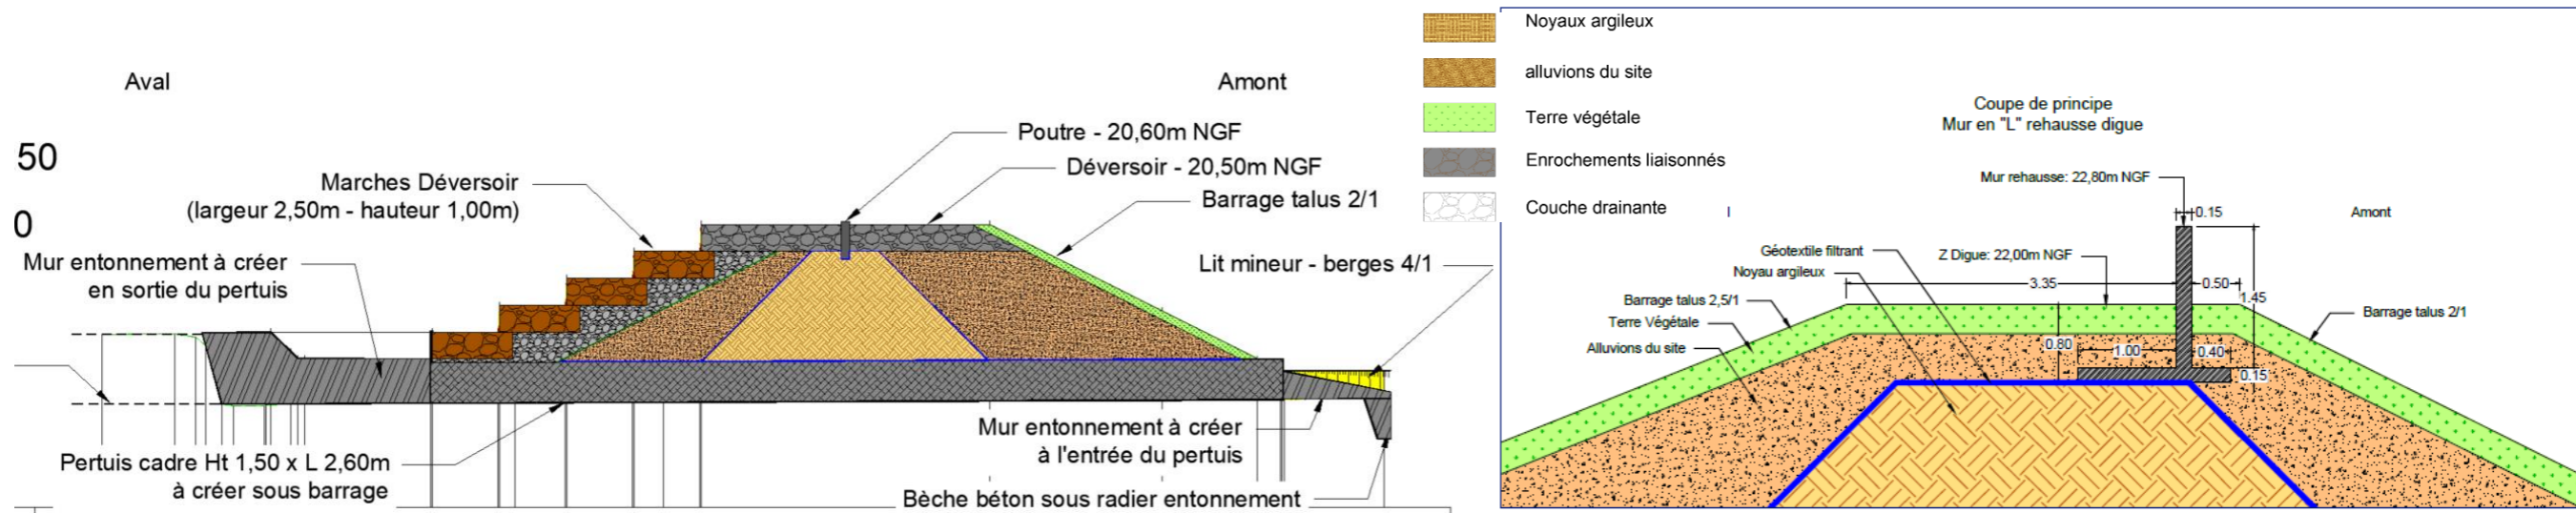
Coupe B-B' de la section déversante à gauche, et de la section courante en rive droite à droite – plan AVP
